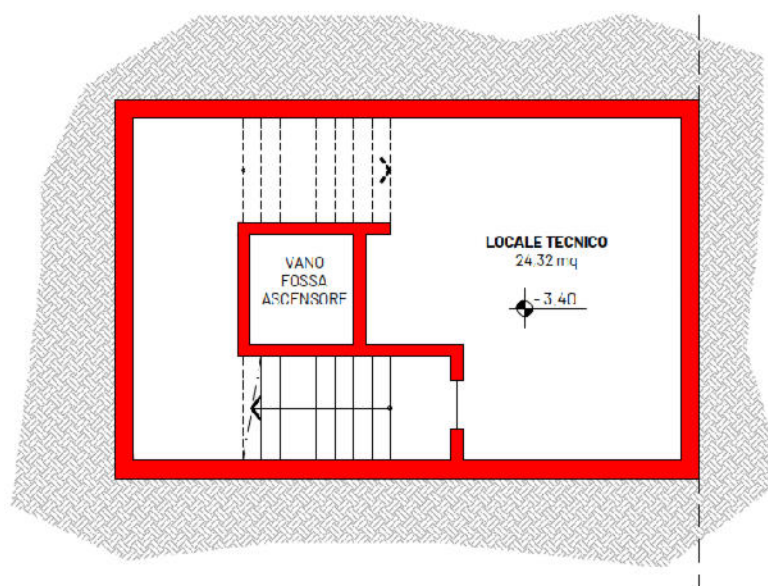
Pianta locale tecnico interrato (da documentazione progettuale)
